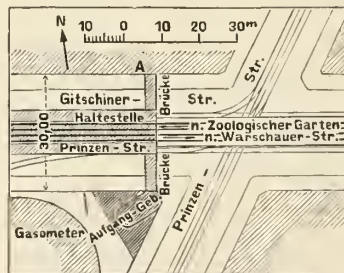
Lageplan. (A Wohnhaus mit eingebautem Treppenaufgang und Schaltterraim.)
